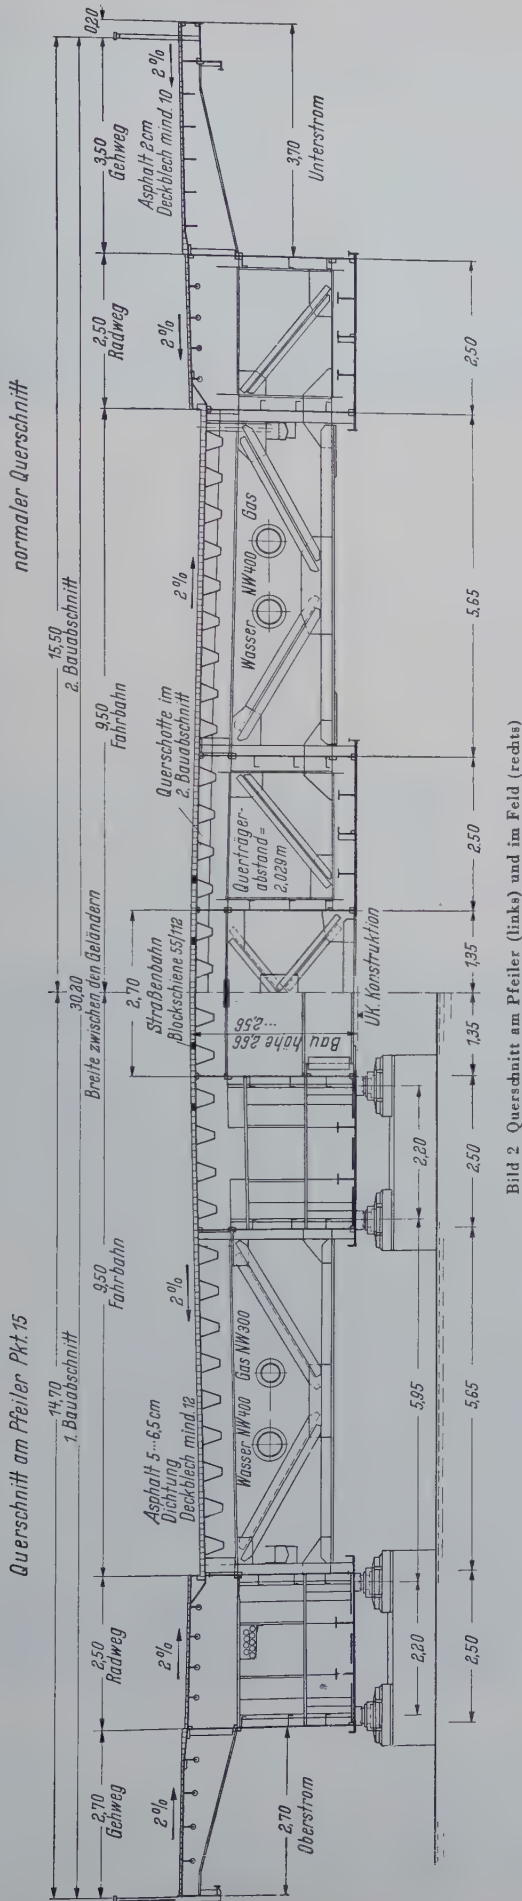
Querschnitt am Pfeiler (links) und im Feld (rechts)
